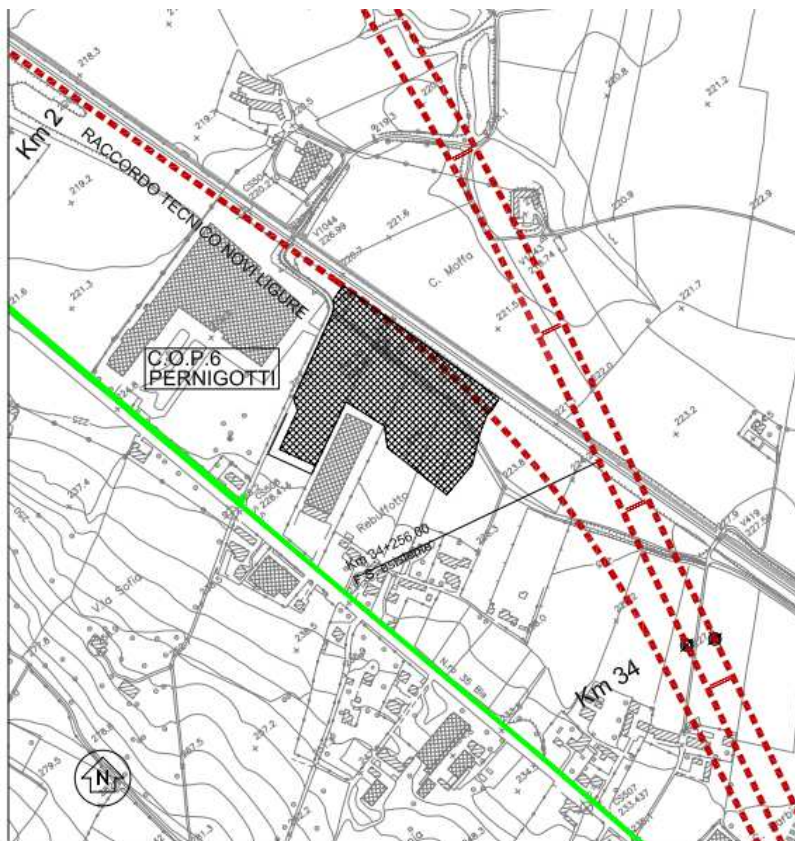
Stralcio planimetrico con indicazione dell'ubicazione del cantiere Operativo C.O.P.6 per la soluzione di Progetto Definitivo
